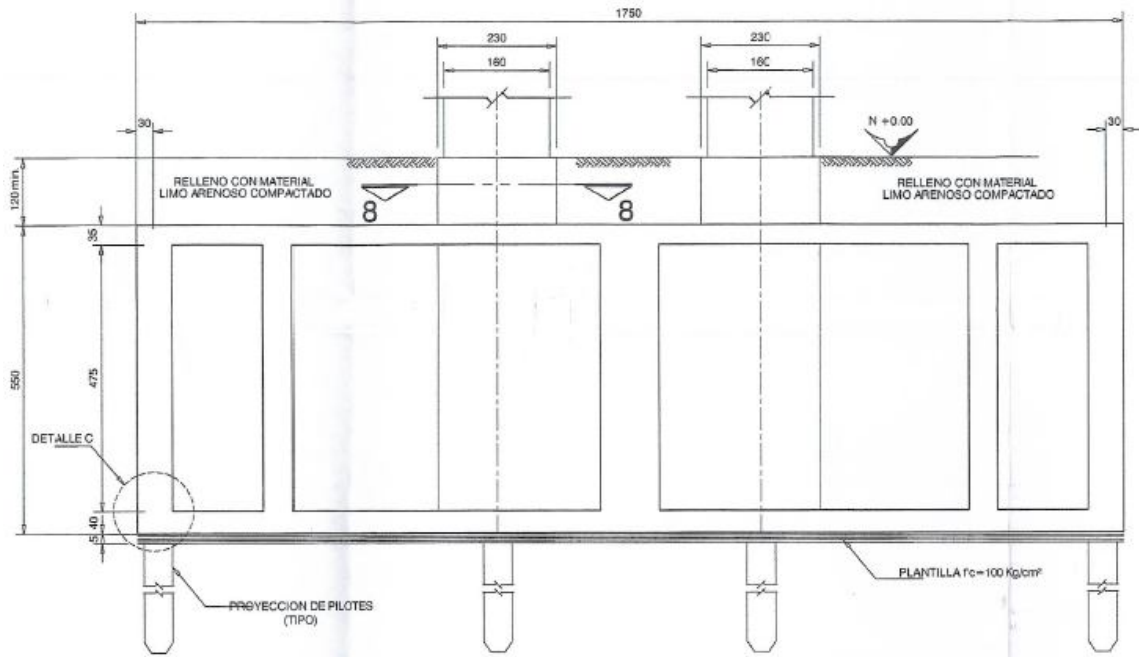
Corte longitudinal de losa de fondo, muros y losa tapa
